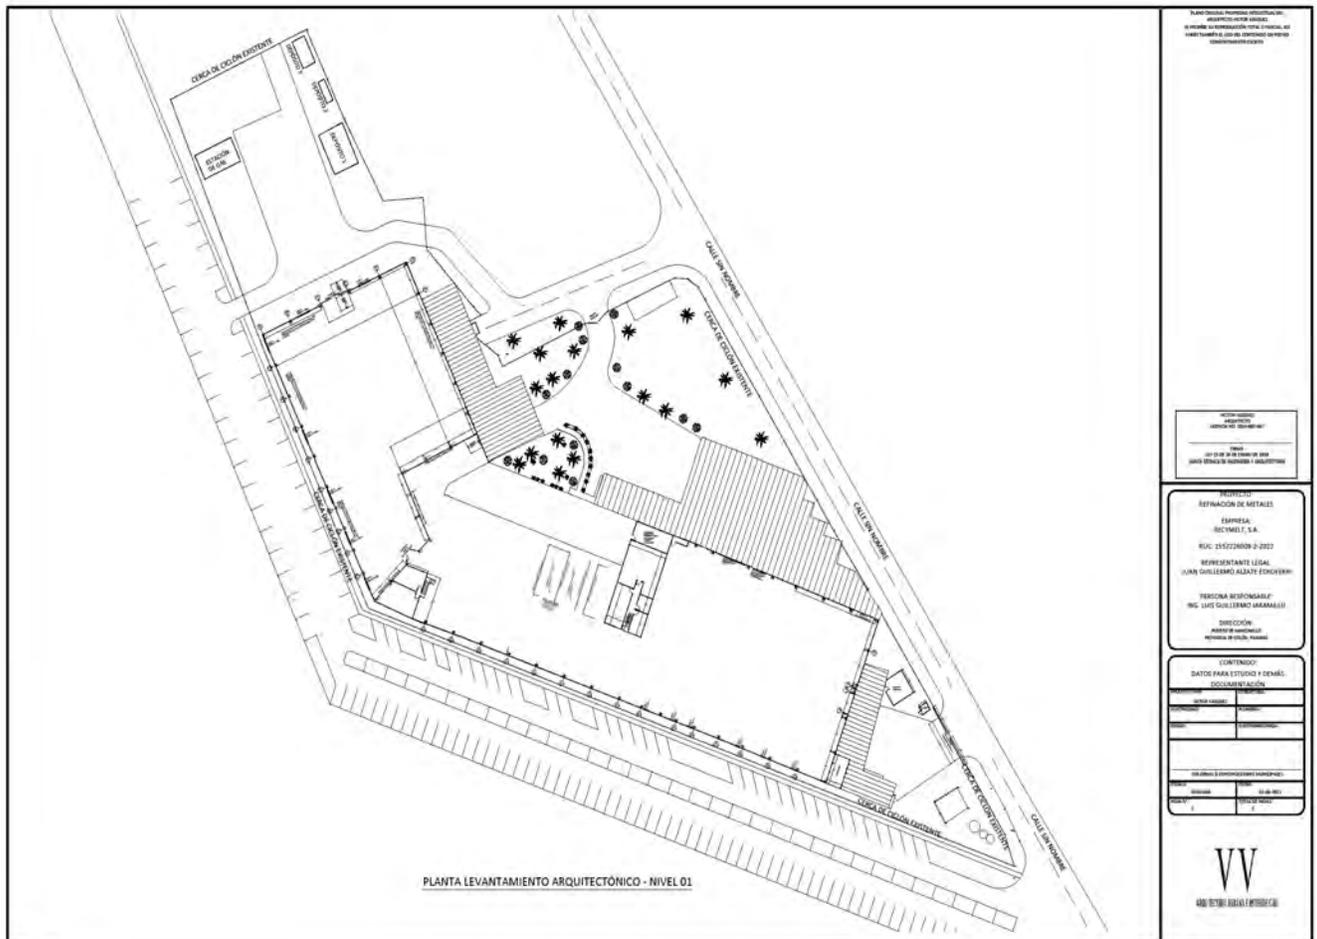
Plano general de la Bodega de Reciclaje de Plomo y Hierro. (Referirse al Anexo 15.24. Planta Levantamiento Arquitectónico - Nivel 01).
